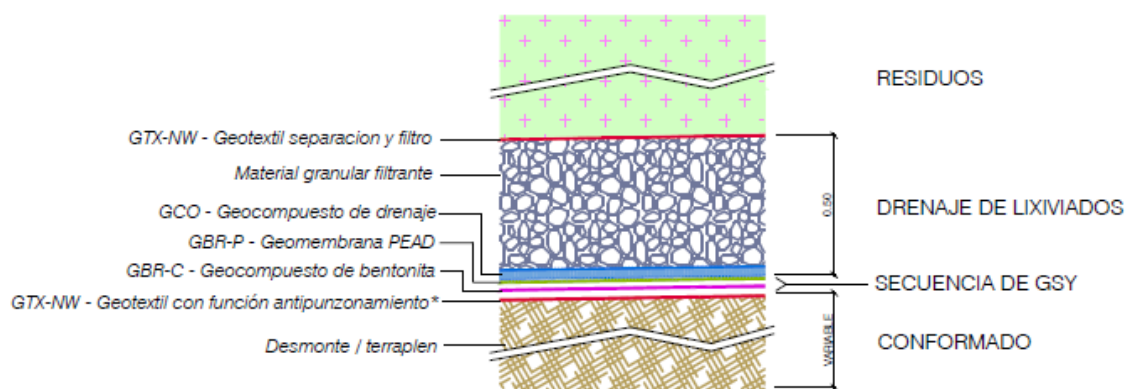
Detalle secuencia impermeabilización en el fondo de vaso
